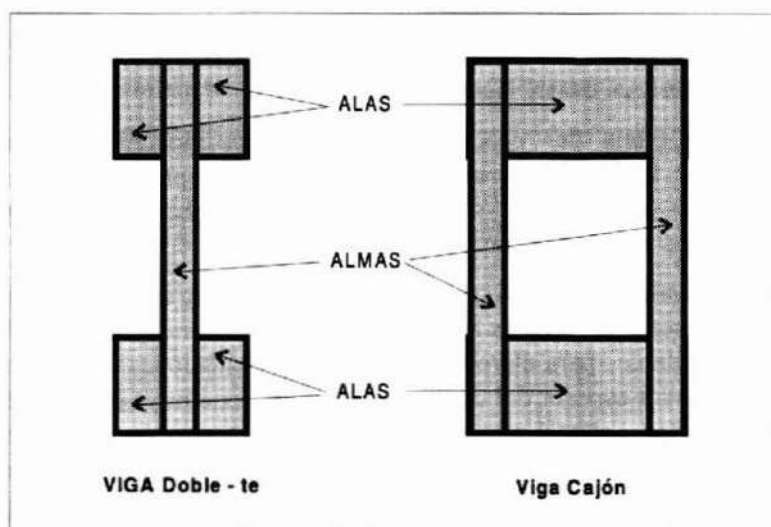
SECCIÓN TRANSVERSAL DE LAS VIGAS ESTUDIADAS.
